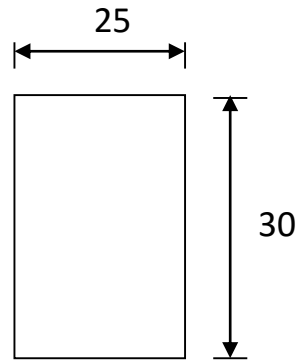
les dimensions de la poutre secondaire en béton armé.
